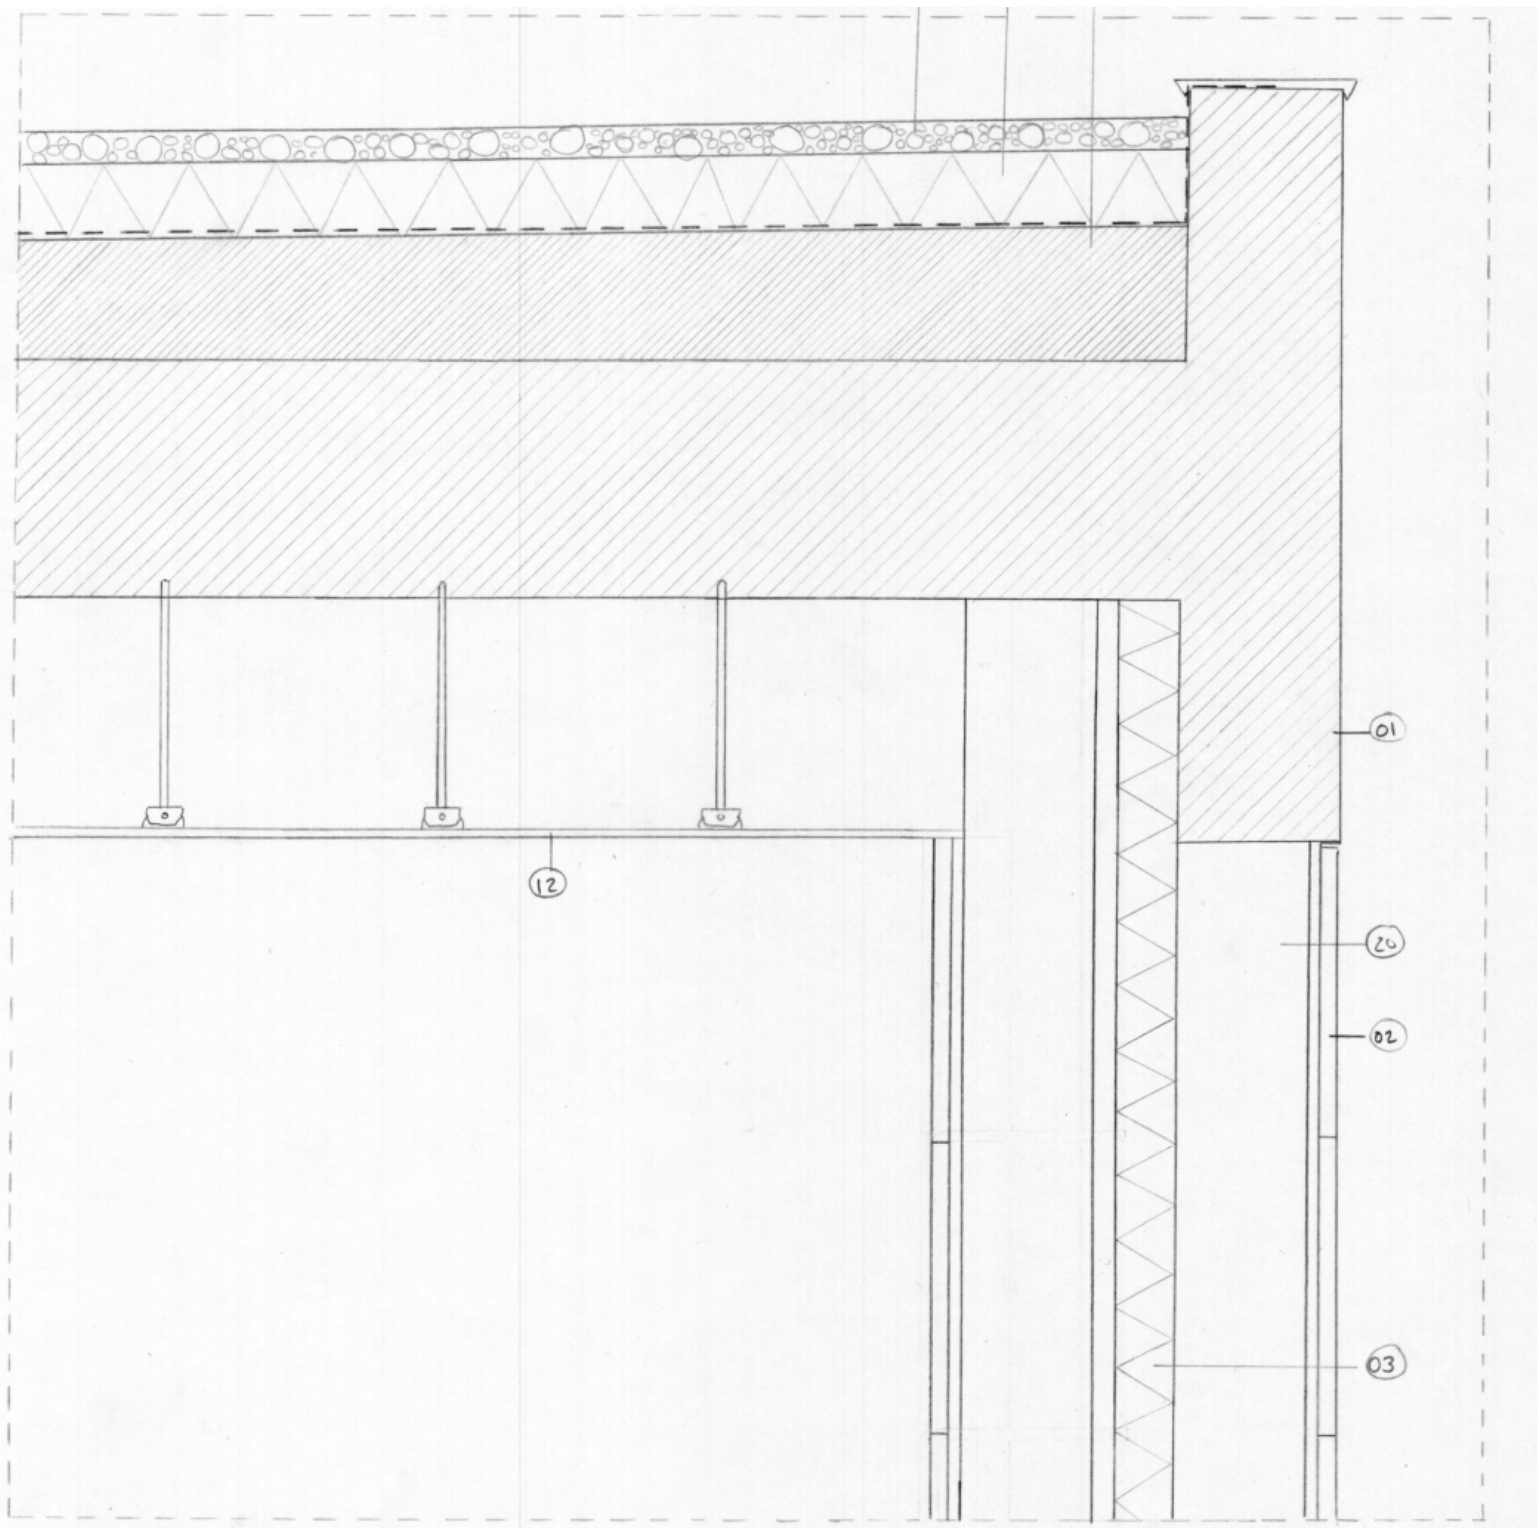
D1 - Detalhe do encontro da cobertura com a parede, escala 1:10.
